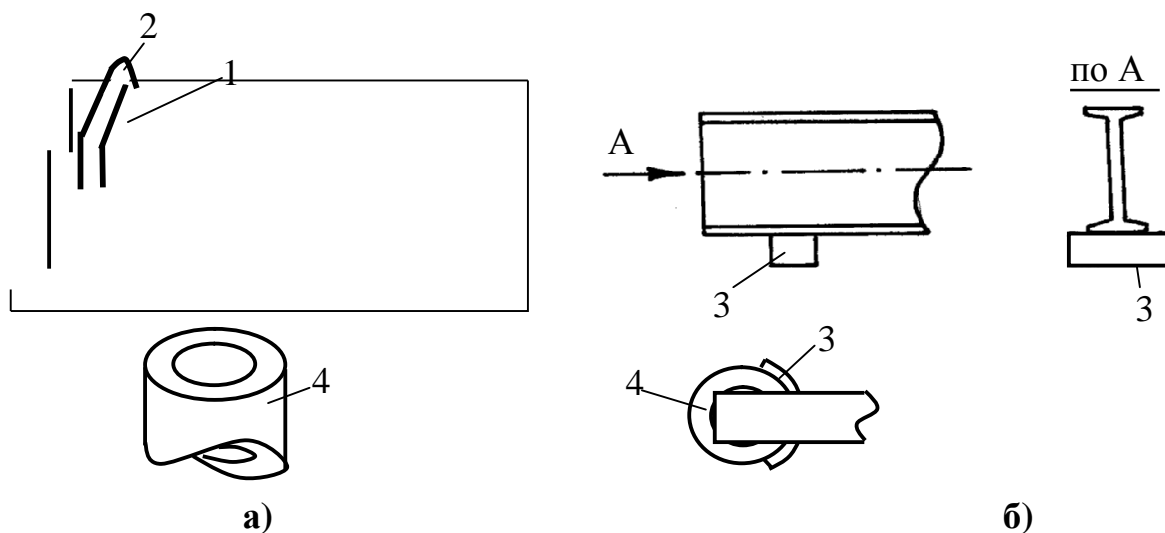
Металевий верхняк із СВП із замковим з'єднанням (а) і двотавра з дугоподібним обмежником (б): 1 – обхват жолобчастий; 2 – приварена скоба; 3 – приварений дугоподібний обмежник; 4 – ЗБС
